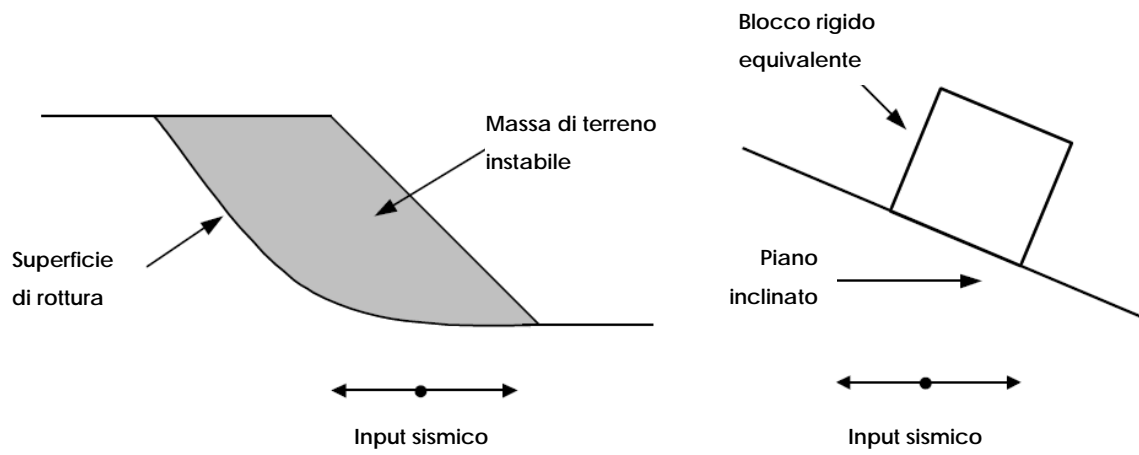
Schema dell'analogia tra massa di terreno instabile e blocco rigido secondo [Newmark \(1965\)](#)
